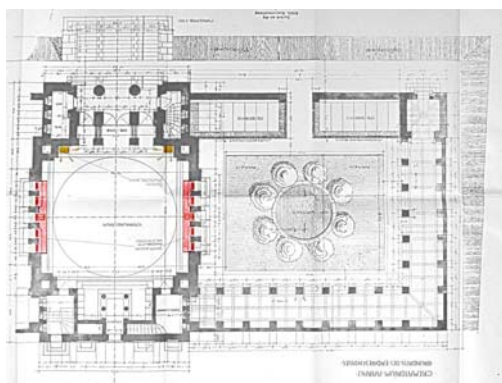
Albert Froelich, Grundriss Erdgeschoss
